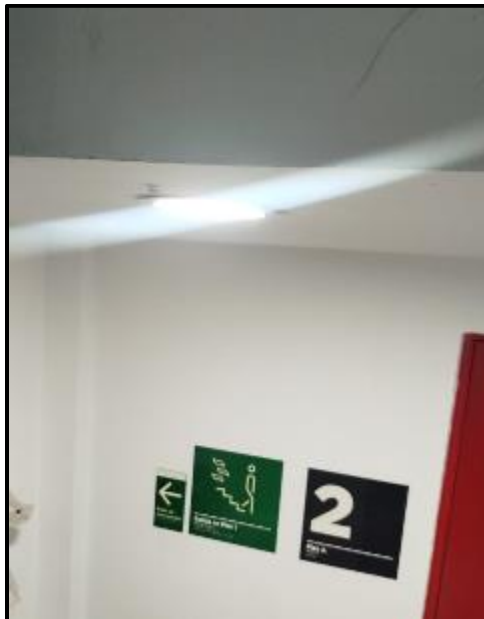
Luminaria instalada en las escaleras de emergencia piso 2
